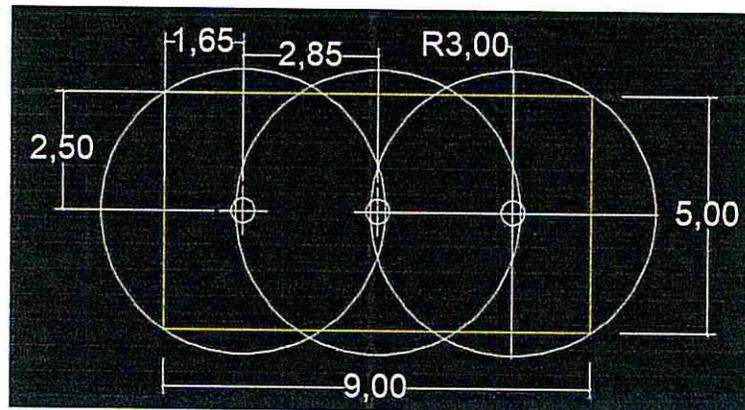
Vista de planta, distribución de los pozos para airear el área impactada A-1.
